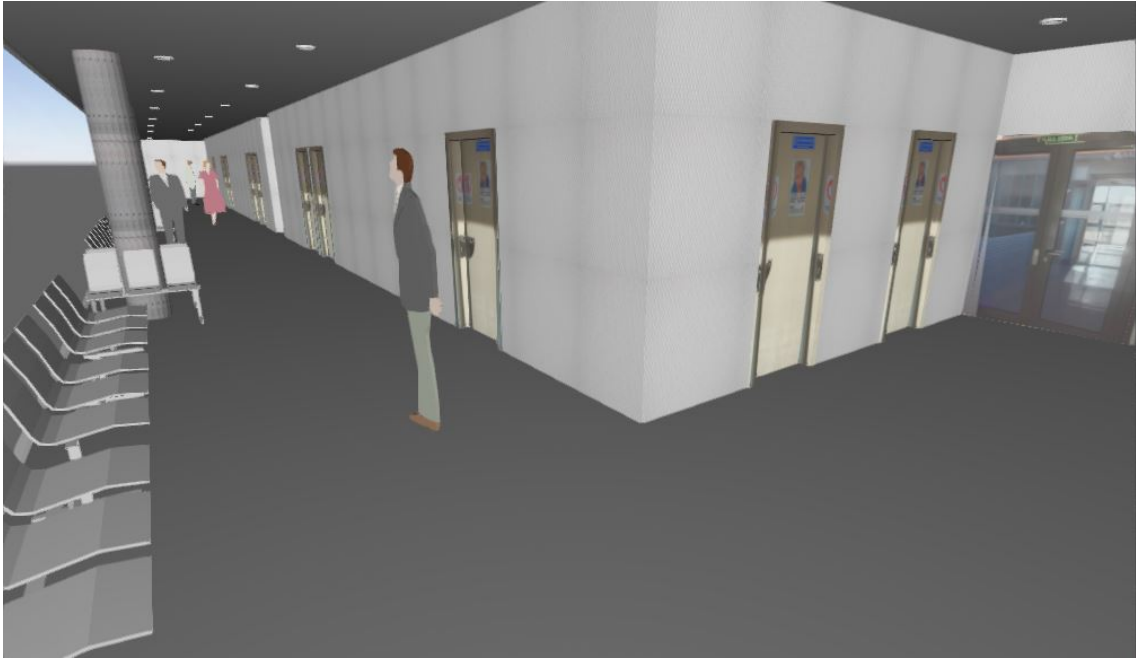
Modelo 3D completo, planta 2º y 3º (2). Fuente: *Elaboración propia
